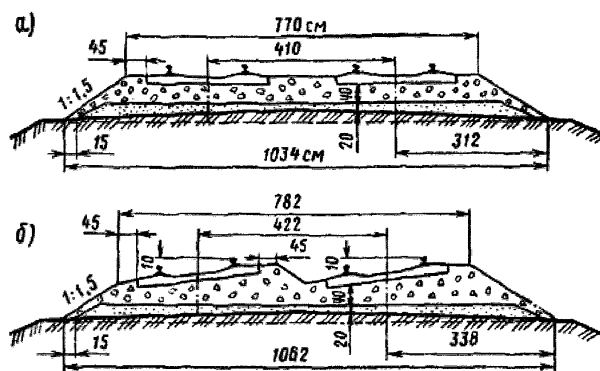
Поперечные профили балластного слоя для пути тяжелого типа при железобетонных шпалах:
